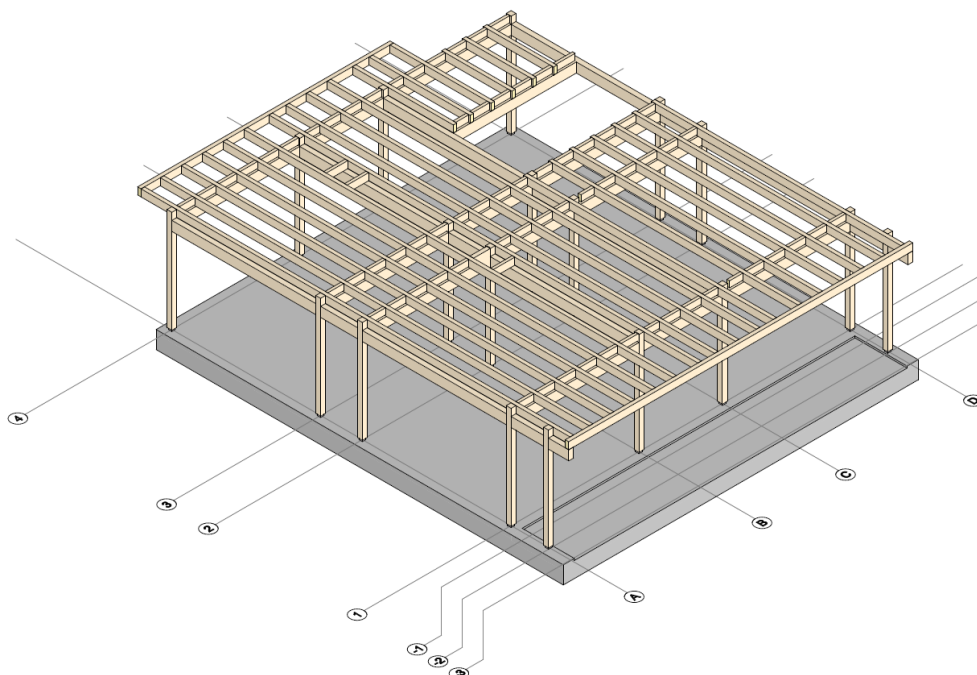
Axonometria da estrutura do piso térreo, e do pavimento do piso 1.
